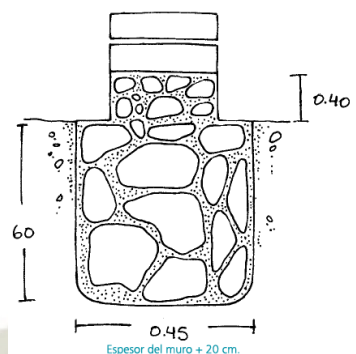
Dimensiones de la zanja. Fuente: (Salud Sin Límites, 2009).
